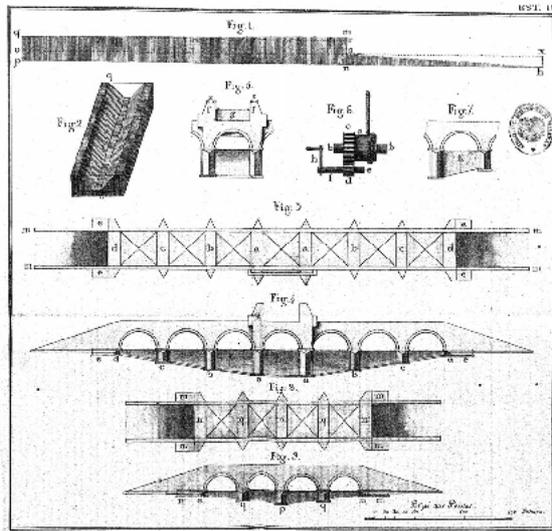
Estudo de Eusébio de Sousa Soares sobre a construção de um canal para protecção de Castro Marim (Tipos de pontes a construir no canal).
